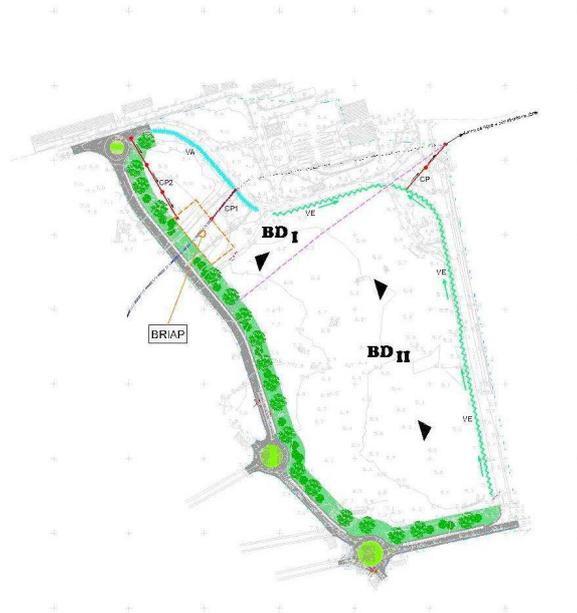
Drenagem Geral da Área do Plano (peça desenhada DP1 do PPZIC)
